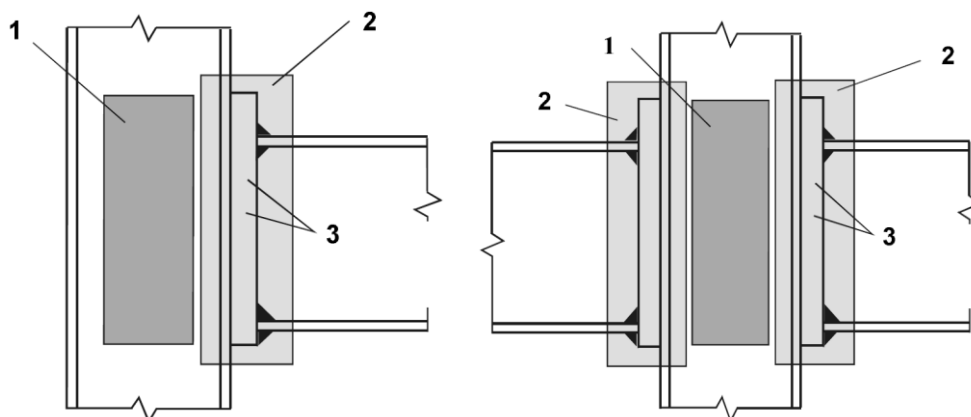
Компоненты узла сопряжения балки с колонной: а – одностороннее примыкание балки к колонне, б – двустороннее примыкание балок к колонне (1 - участок стенки колонны, работающий на сдвиг; 2 – соединение; 3 – опорный фланец с элементами соединения)
